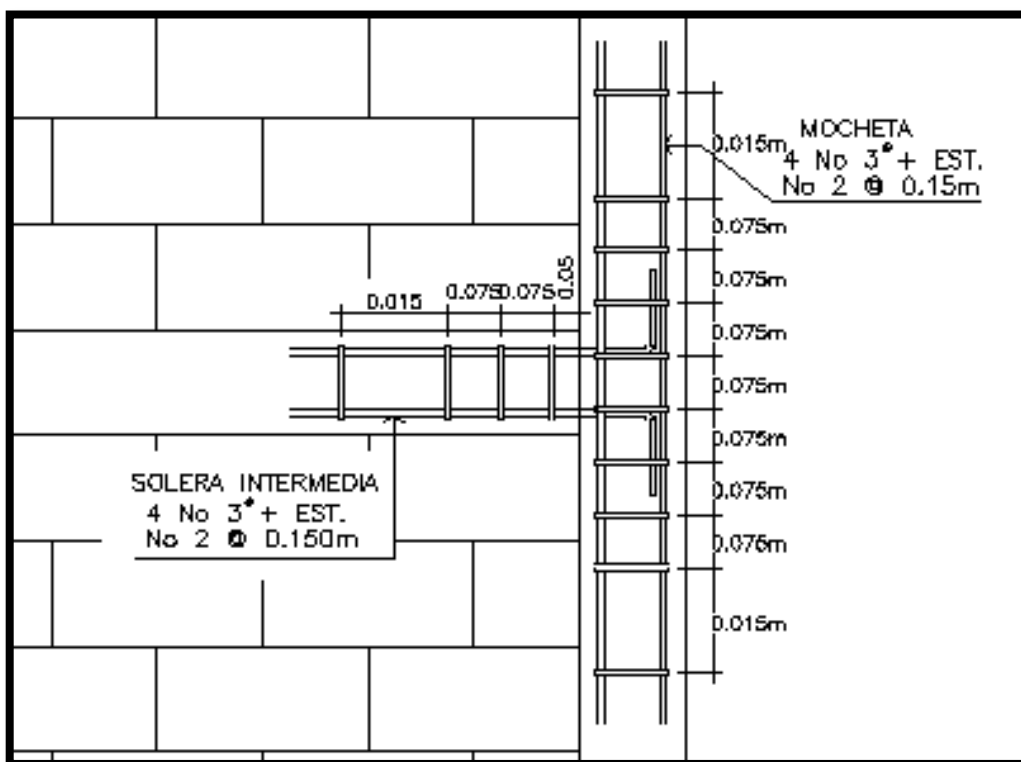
Detalle 2 de armado de columnas de muro con solera.
